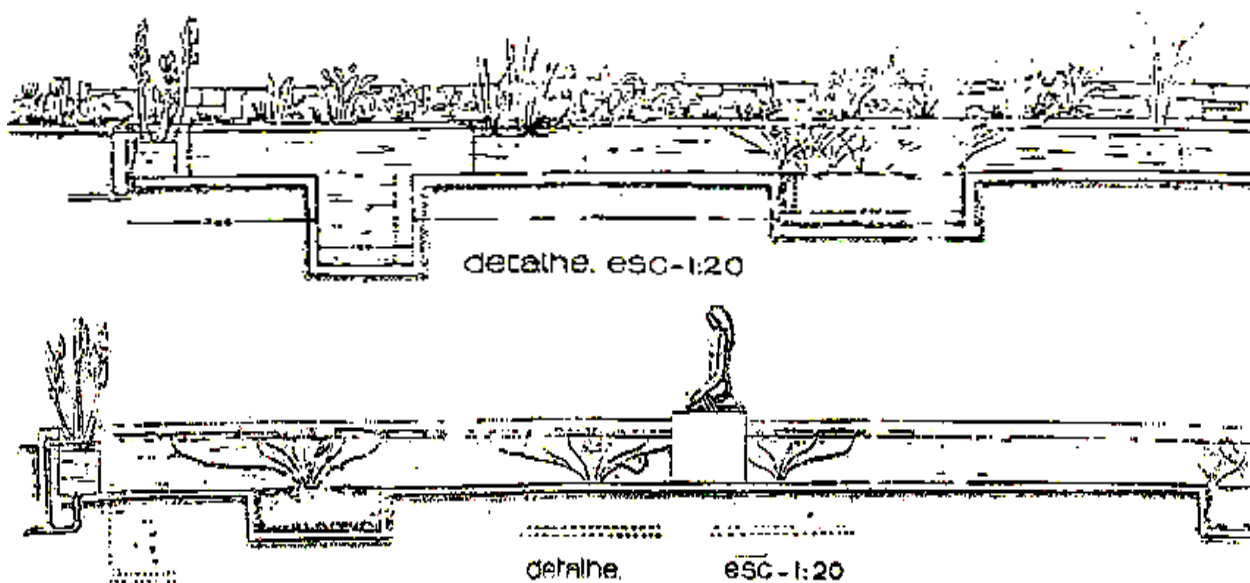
Detalles de los lagos de la Plaza de Casa Forte. Se destacan las jardineras de plantas acuáticas y terrestres y el sistema hidráulico. Acervo: Laboratorio del Paisaje/UFPE.
